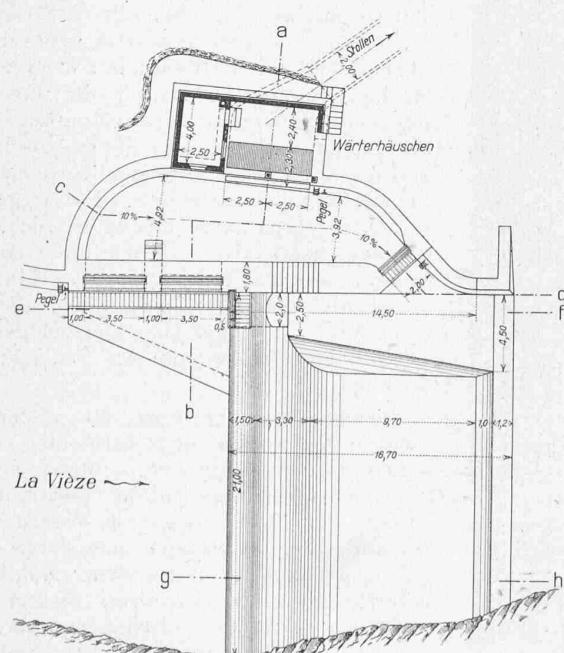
Grundriss von Wehr und Fassung. — 1:400.
